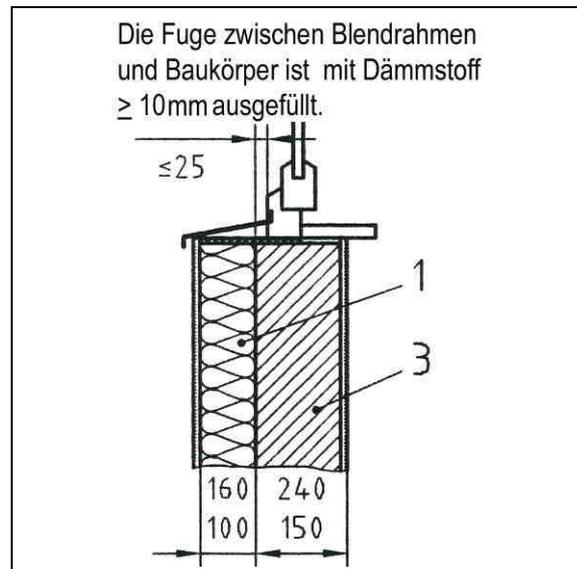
Fensterbrüstung, außen gedämmtes Mauerwerk [aus: DIN 4108 Bbl. 2:2006-03; Abb. 43]
